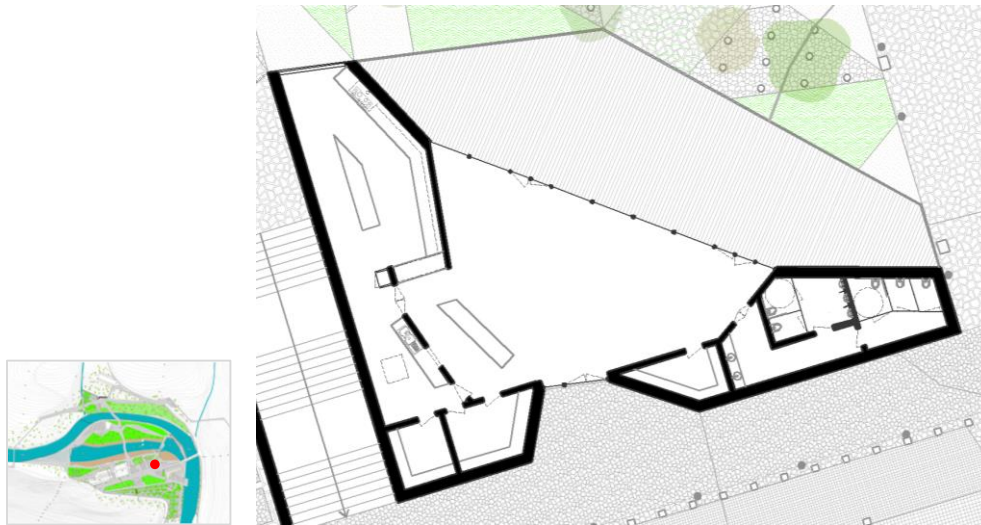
Planta do restaurante; Fonte: Autoria Própria.
